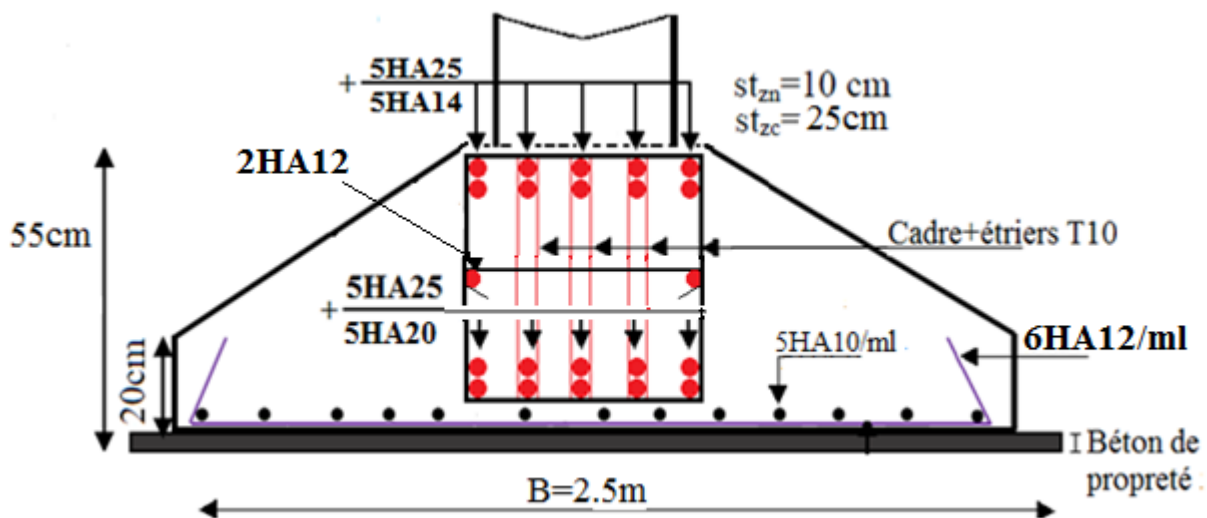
Exemple de schéma de ferrailage de la semelle filante D
